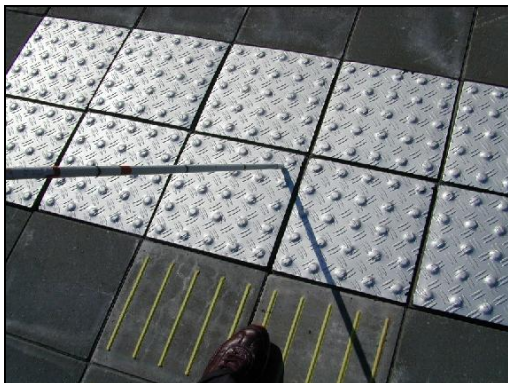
Piso metálico instalado en entorno de concreto. Fuente: www.tactileguideways.com
